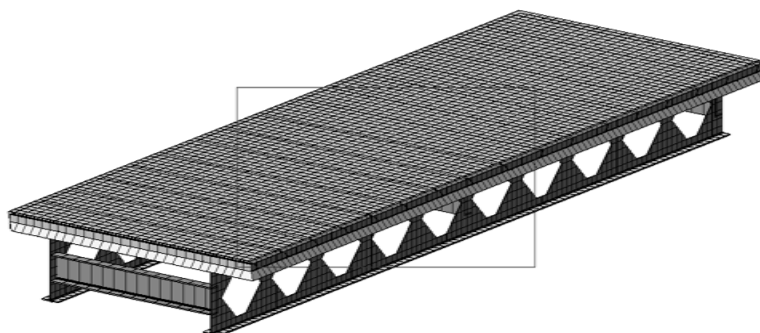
Конечно-элементная модель пролетного строения со сквозными балками, объединенными железобетонной плитой на металлическом поддоне
